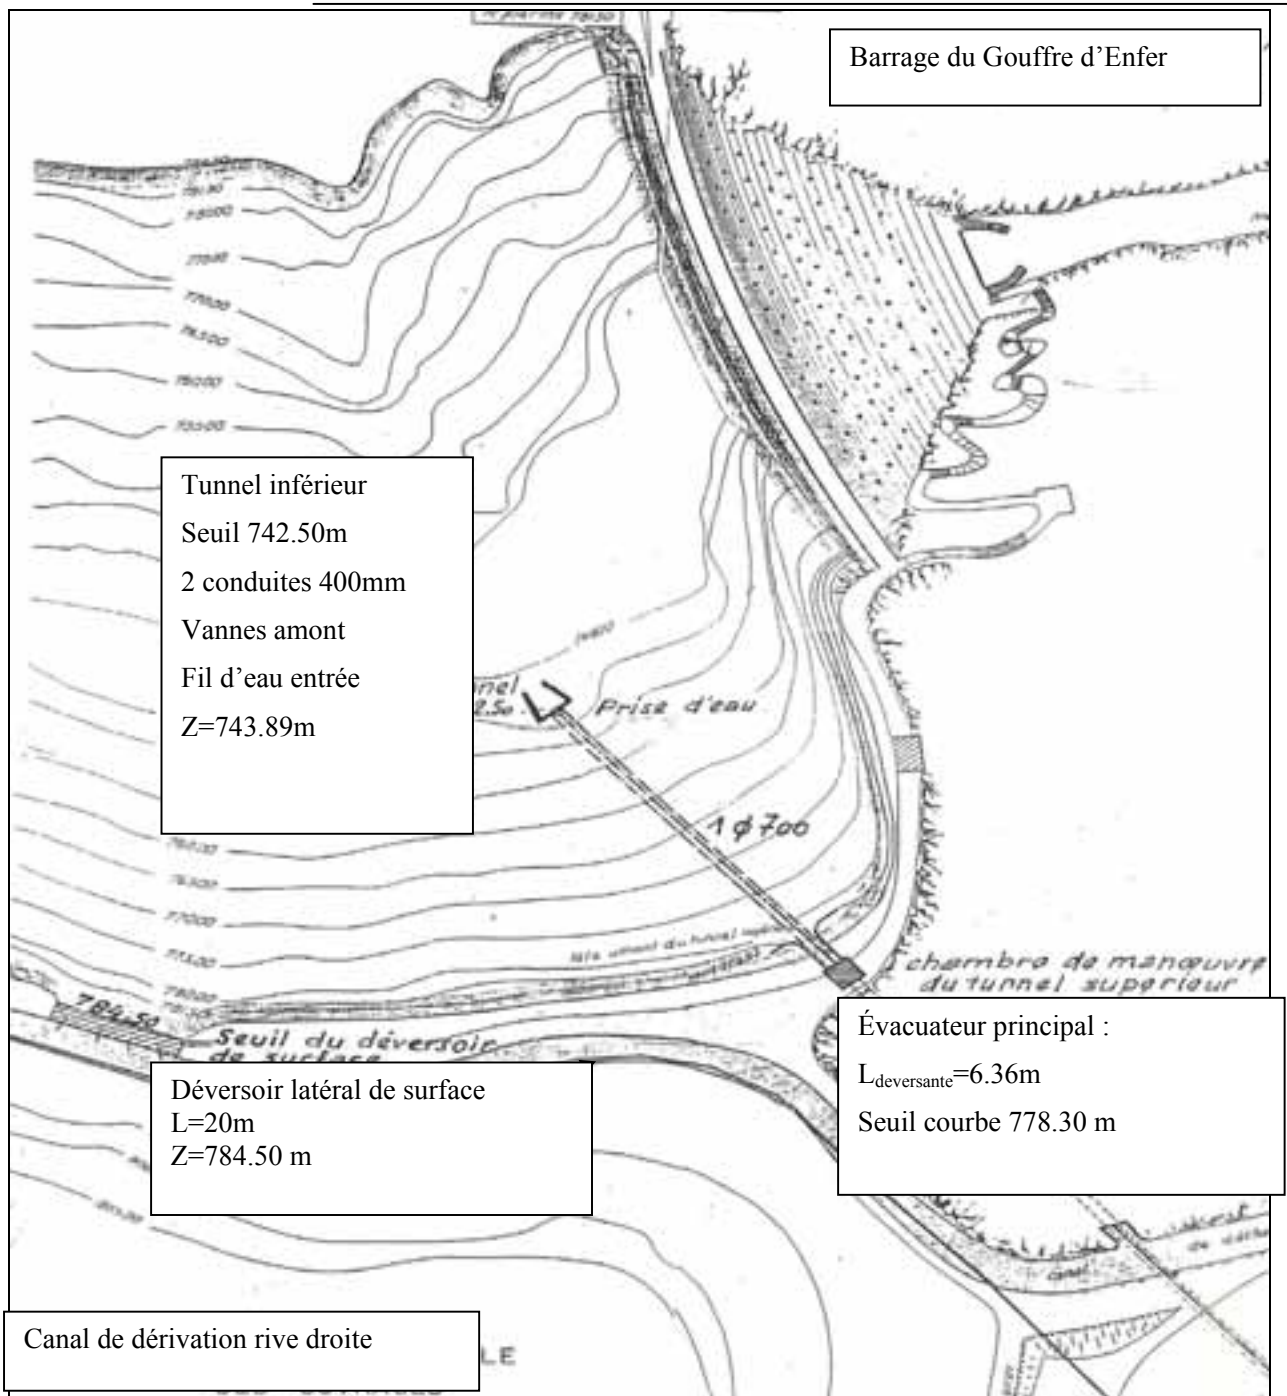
Plan schématique d'ensemble de l'ouvrage (Source Coyne et Bellier)
